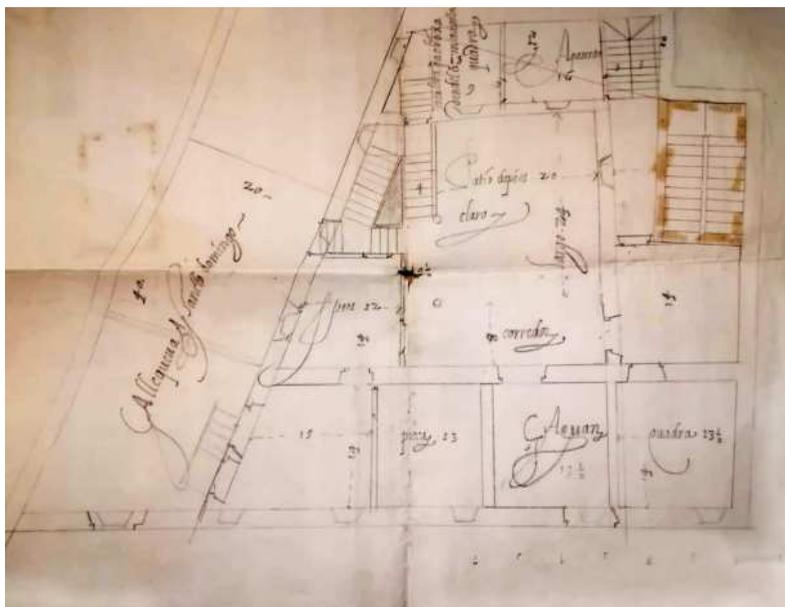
Dibujo de la planta baja de la Casa Grande.
